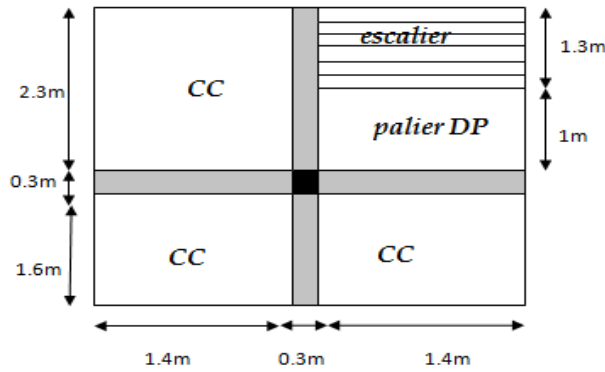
surface afférente poteau p1 terrasse inaccessible.
